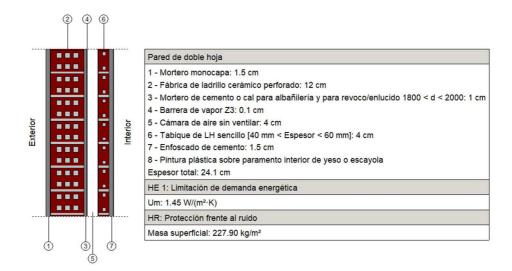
Detalle constructivo de cerramiento planta primera, segunda y tercera.⁴⁷
